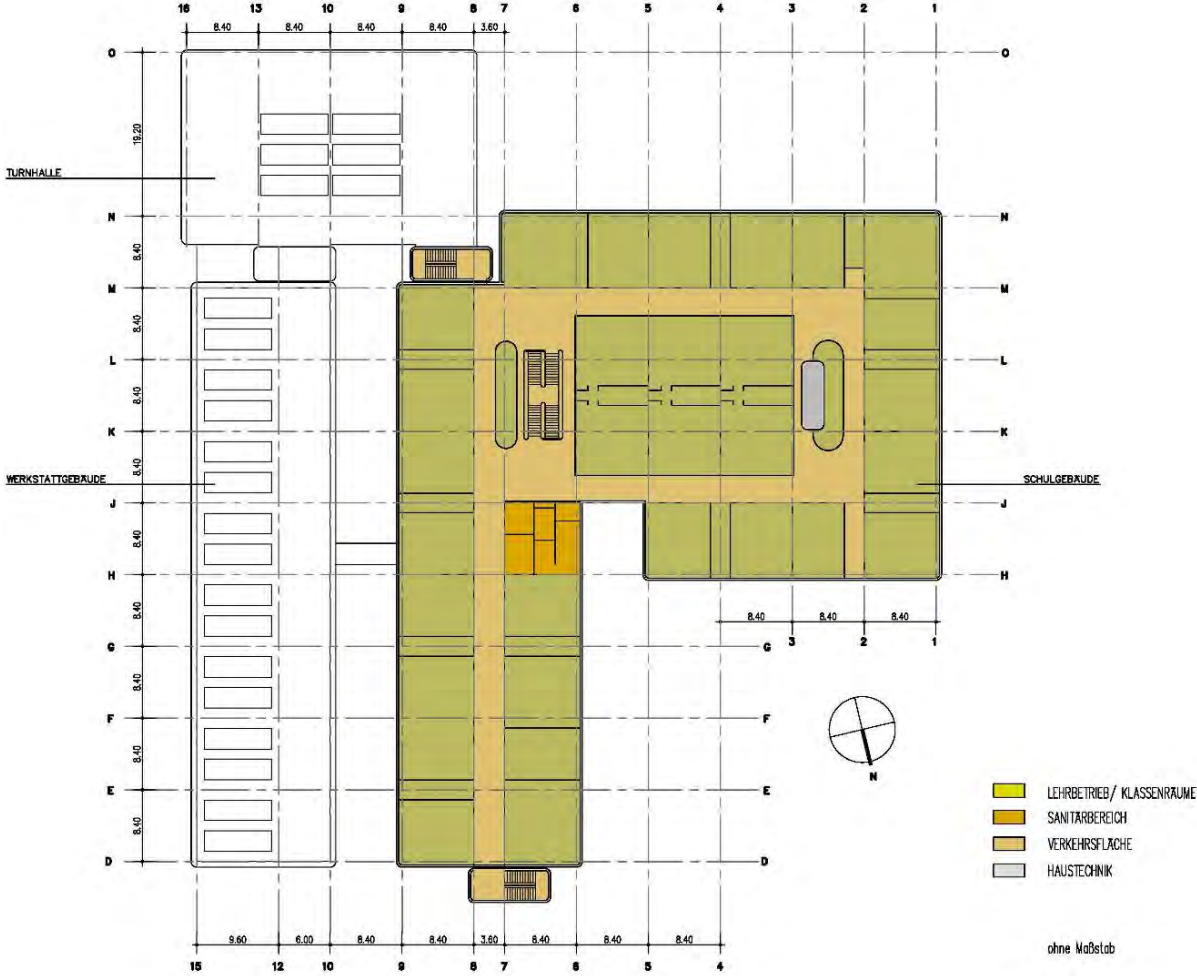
Grundriss OG (ohne Maßstab)
